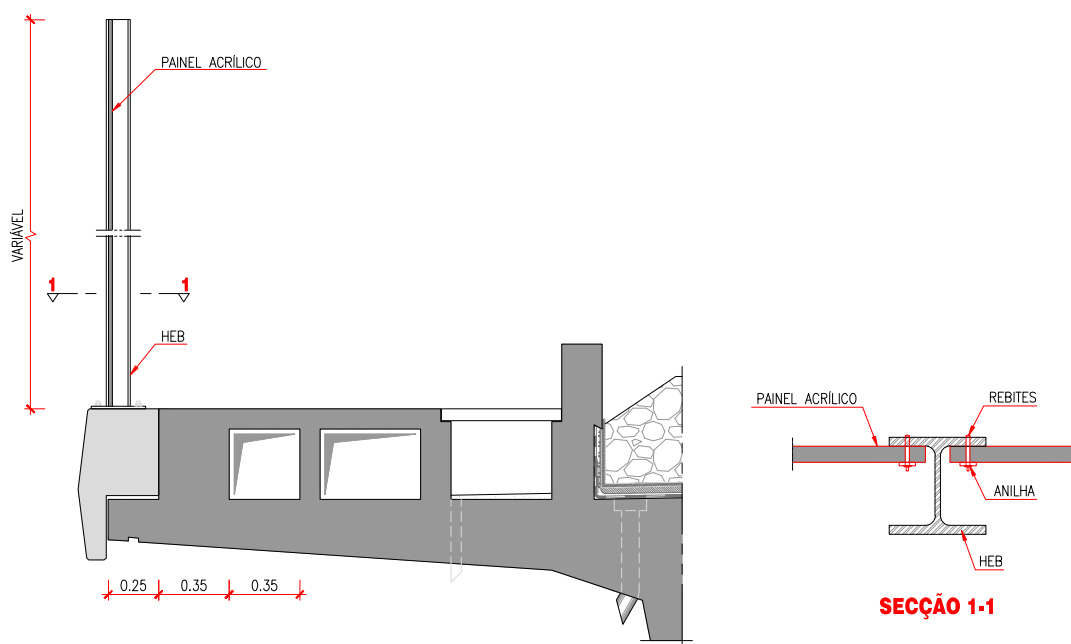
Esquema de Implantação das Barreiras Acústicas
